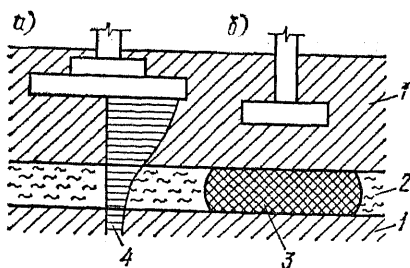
Варианты устройства фундаментов при напластовании грунтов по схеме III
